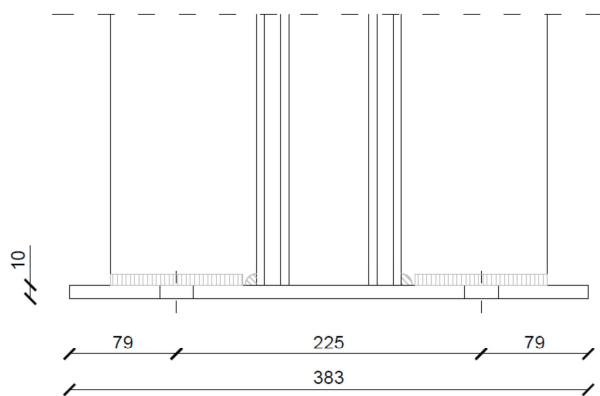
Vista in pianta del collegamento a terra dei montanti ad T
